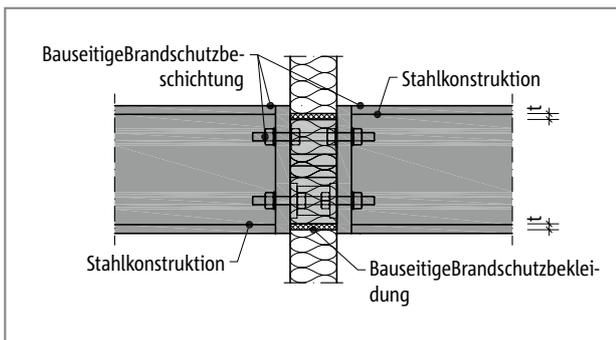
Brandschutz Schöck Isokorb® T Typ S: Bauseitige Brandschutzbekleidung T Typ S, brandschutzbeschichtete Stahlkonstruktion; Schnitt
